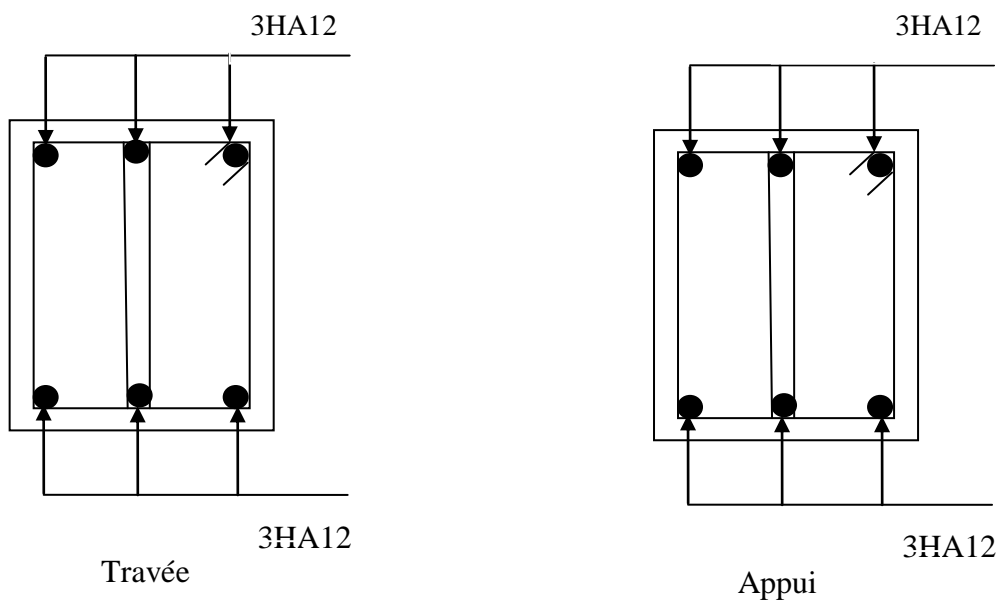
Schéma de ferrailage de la poutre principale (30×40) de la terrasse
